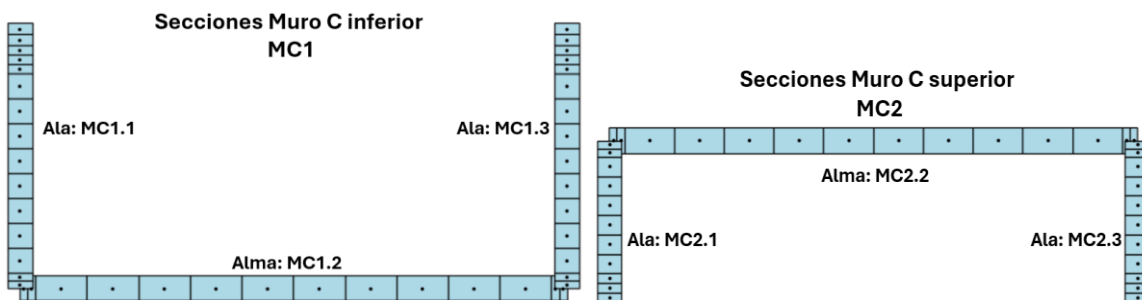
Esquema general en planta de discretización de fibras de muros tipo C y sus secciones; utilizando elemento MVLEM-3D.
